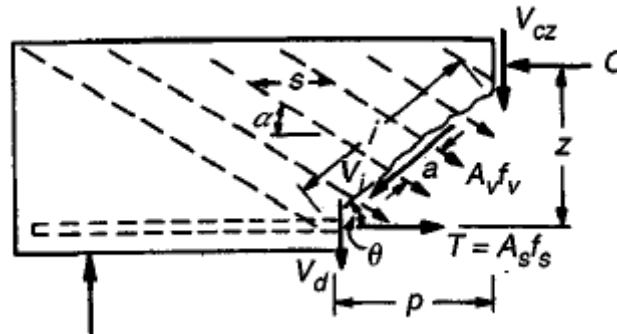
Fuerzas en una grieta diagonal de una viga con estribos inclinados
